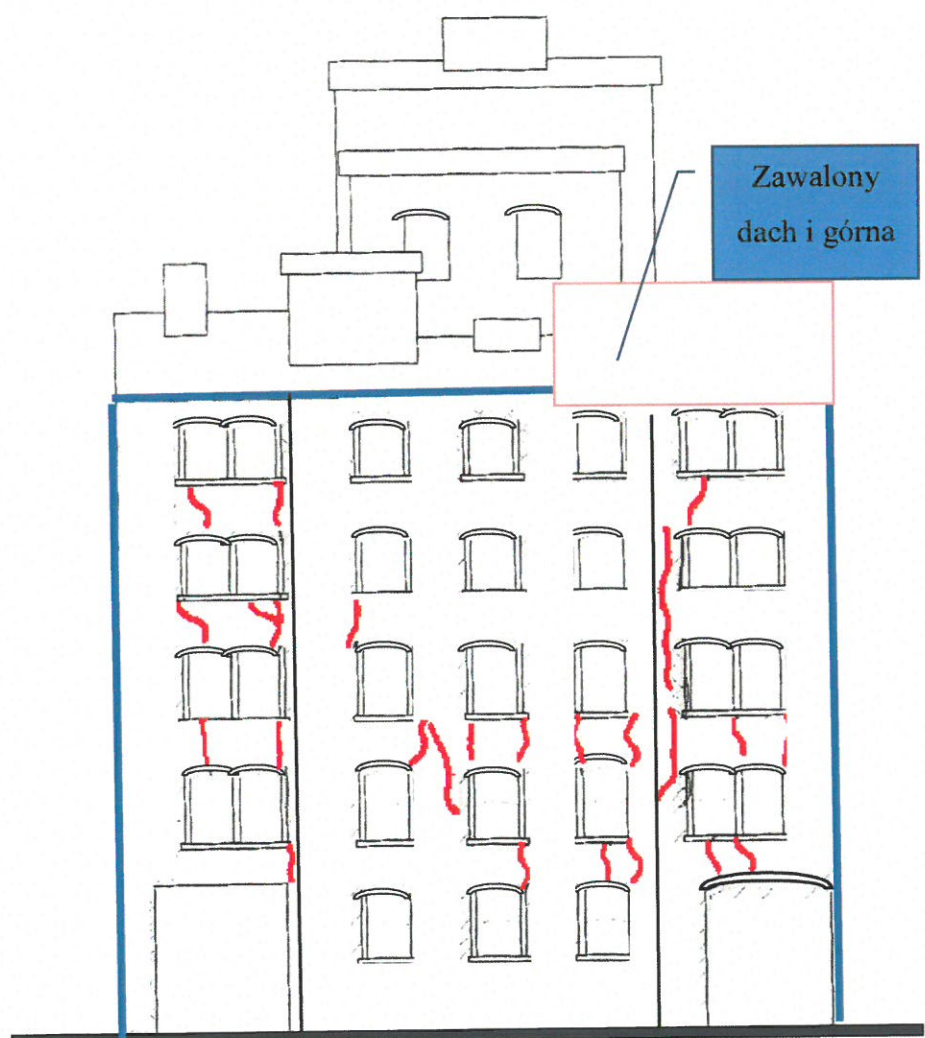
Rysunek elewacji zachodniej z zaznaczonymi rysami w ścianach.
